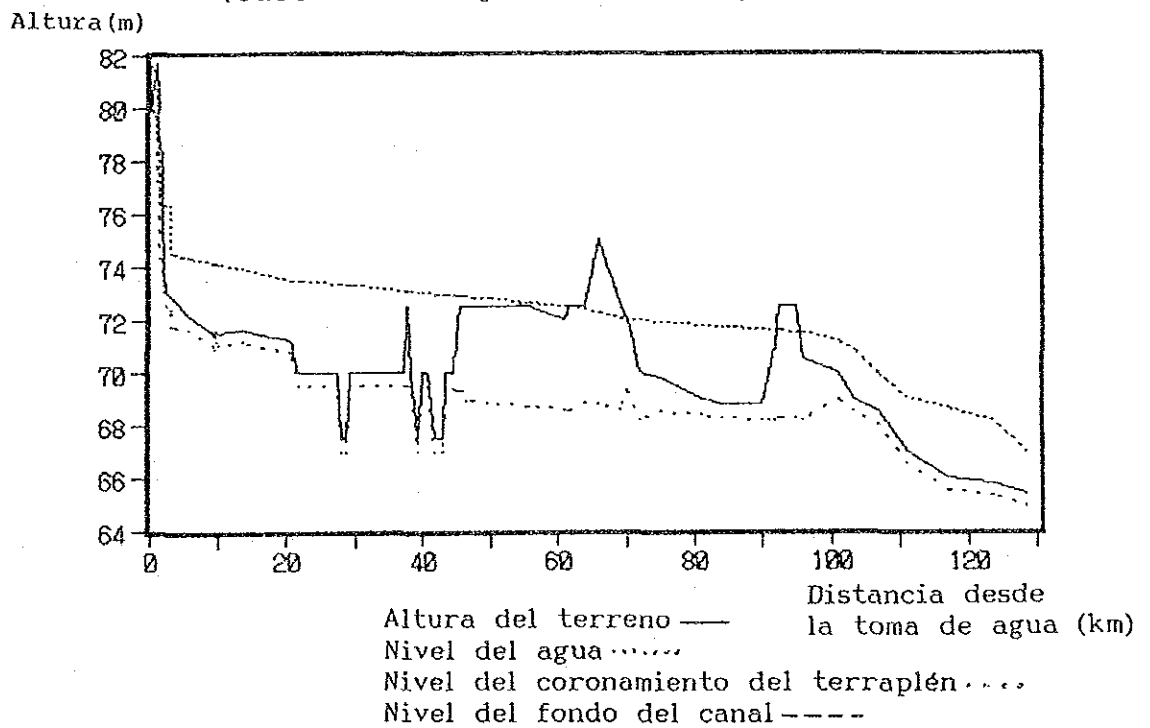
Perfil longitudinal del canal maestro de riego
